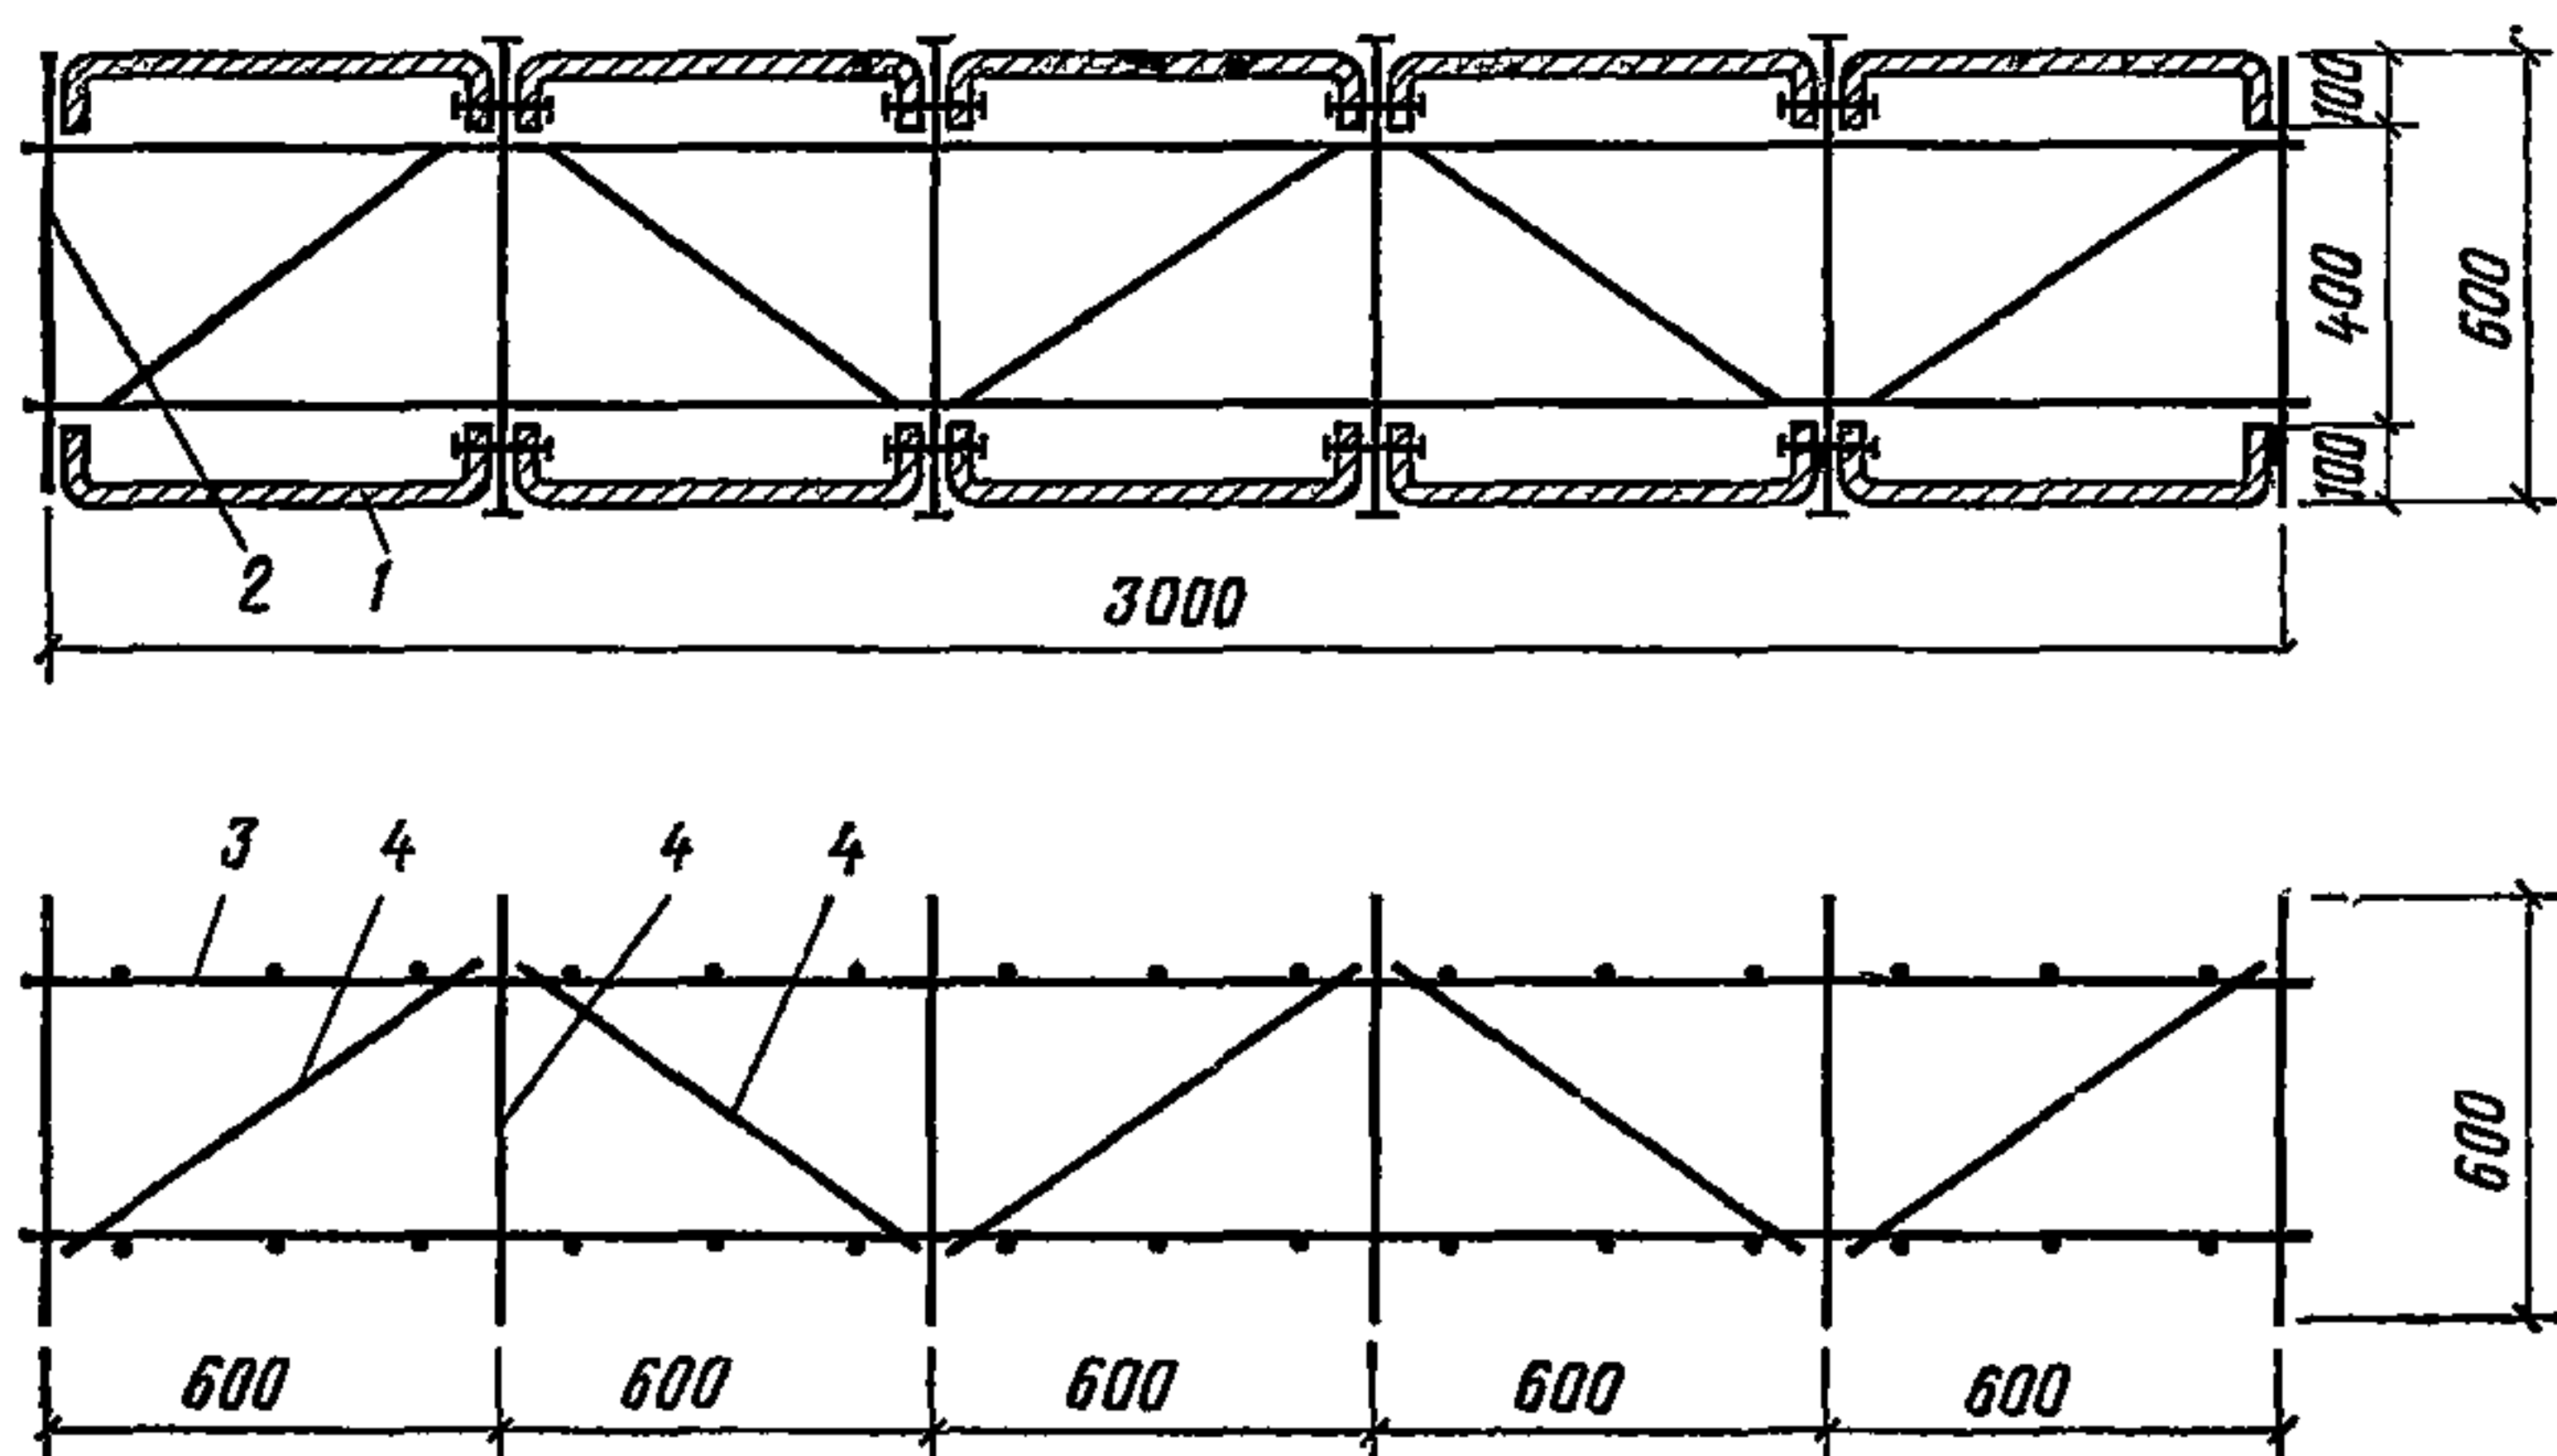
Армоопалубочный блок для армирования стен с использованием профильных опалубочных плит;
